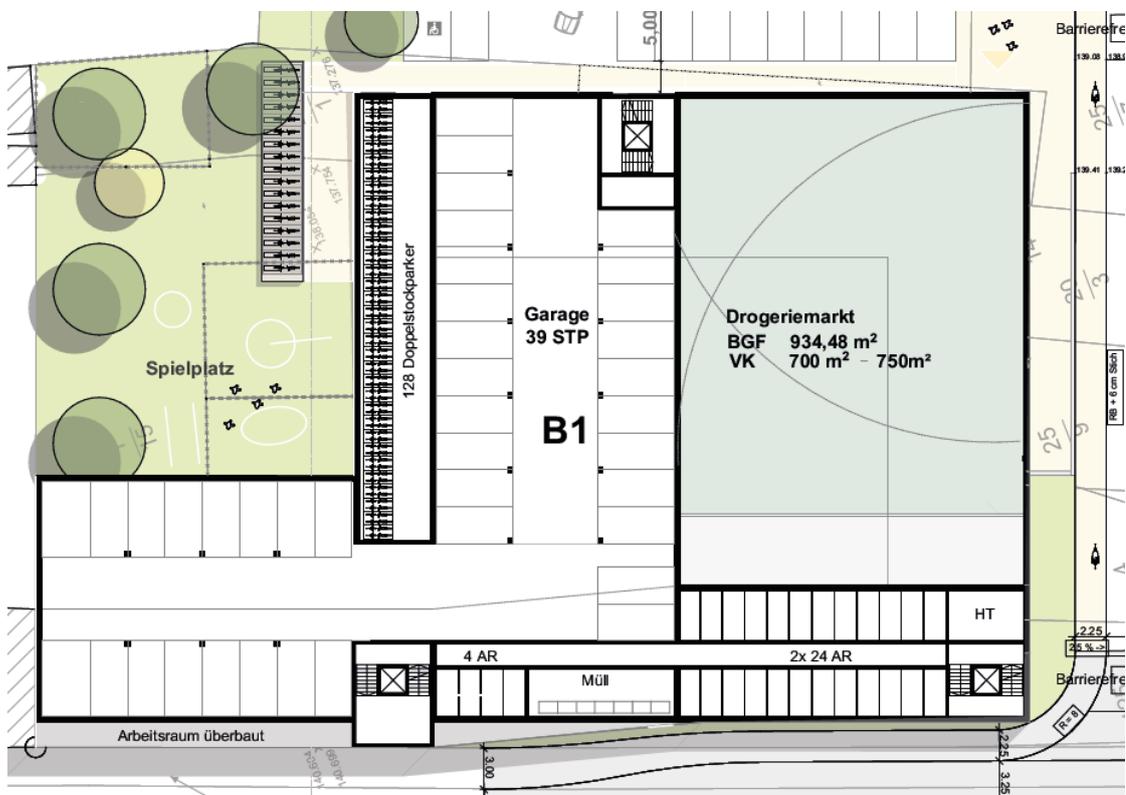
Grundriss unterstes Geschoss mit Drogeriemarkt und Gemeinschaftstiefgarage der Gebäude B1a und B1b
